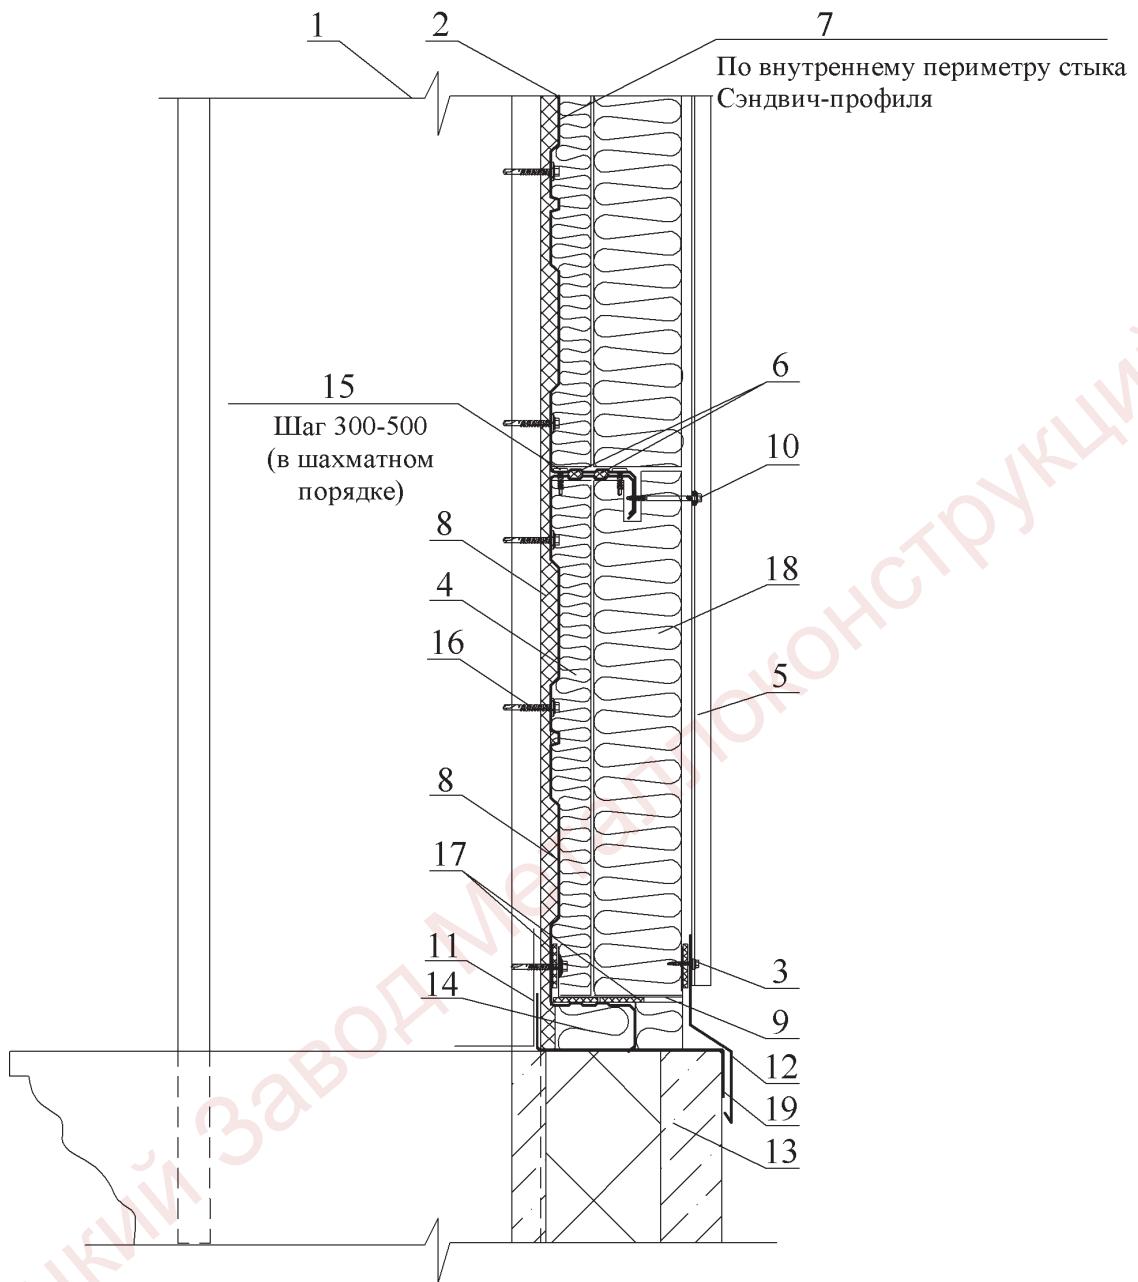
Вертикальный и горизонтальный разрез ограждающих конструкций стен из сэндвич - профиля
